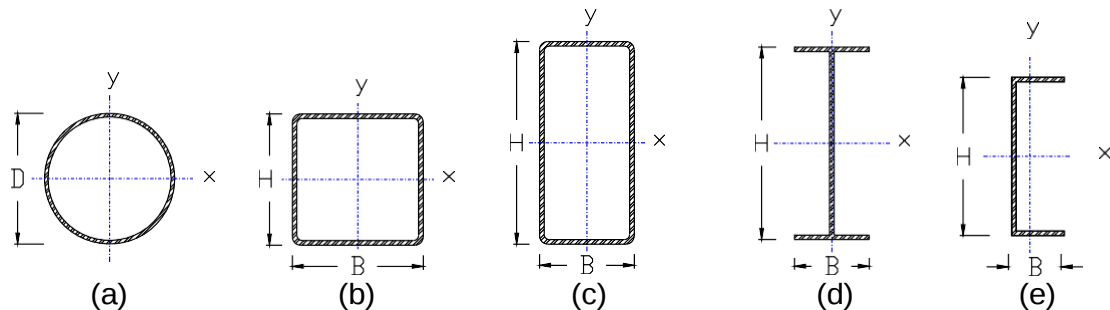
Secciones rigidizadas (a), (b), (c) y secciones no rigidizadas (d) y (e)
